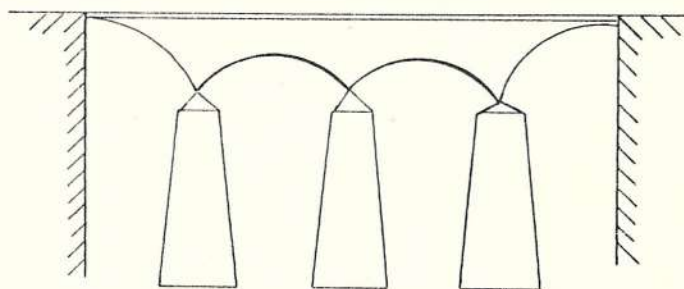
PUENTE DE CUATRO VANOS, ESTRUCTURA METALICA Y TABLERO DE HORMIGON.
